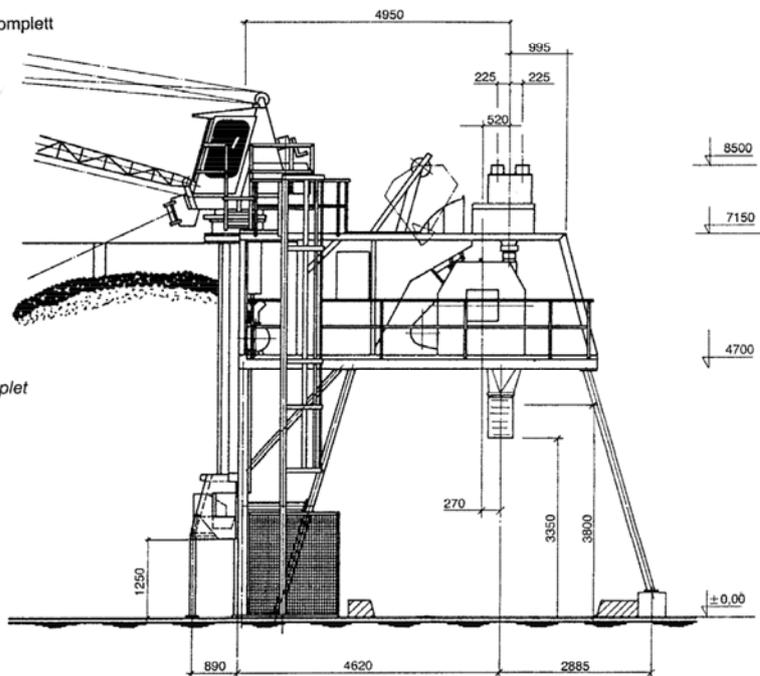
und 12-17: Betonmischanlagen: ELBA Mixcenter EMC 45 / EMC 60 [7]
